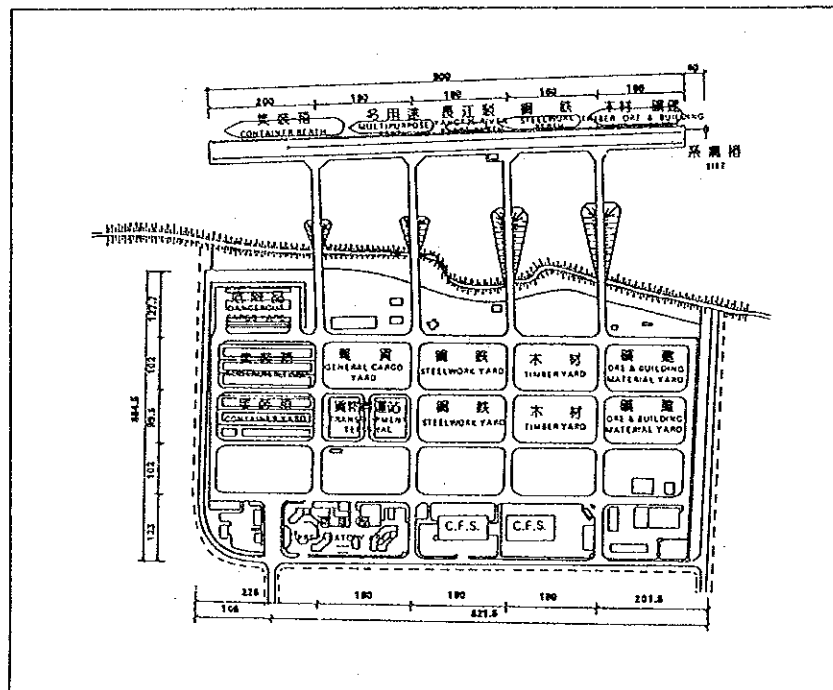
外高橋新港区第Ⅰ期計画平面図
